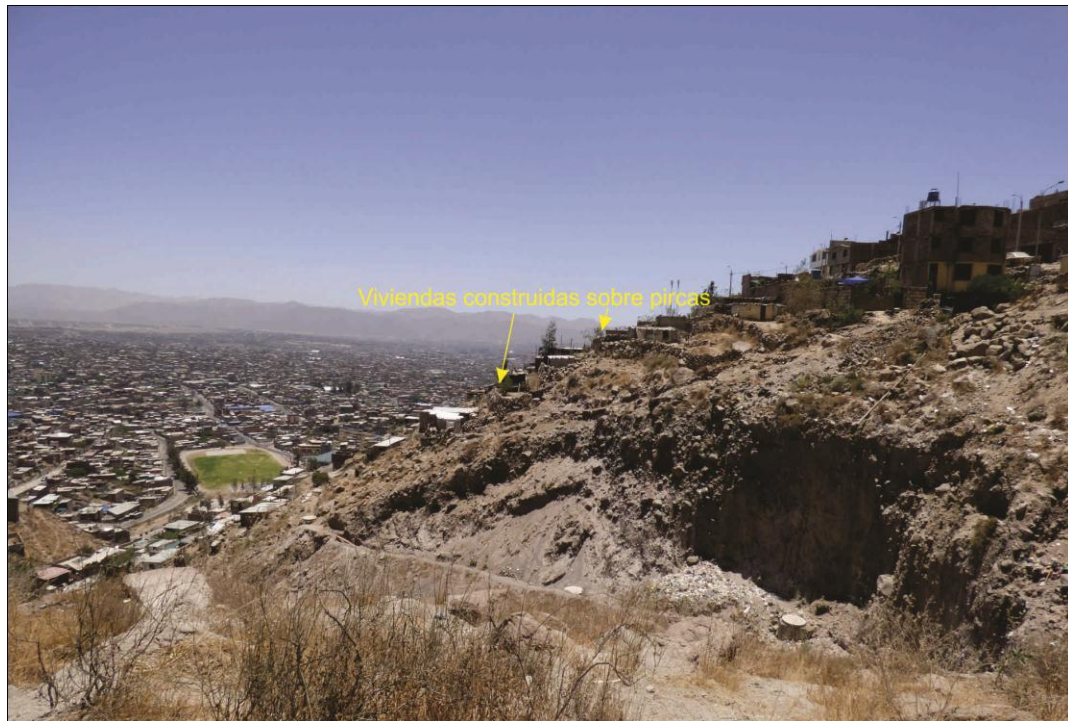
Viviendas asentadas en laderas de fuerte pendiente.
